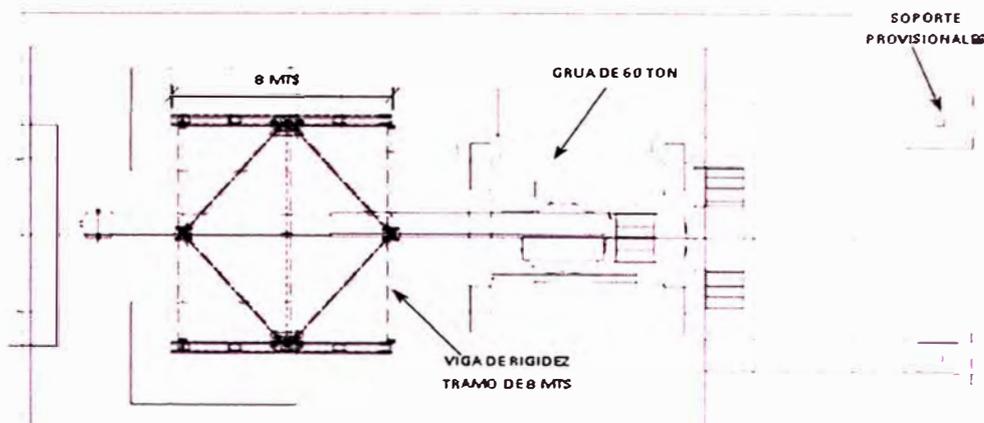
ARMADO DE MÓDULOS EN LA CÁMARA DE ANCLAJE
